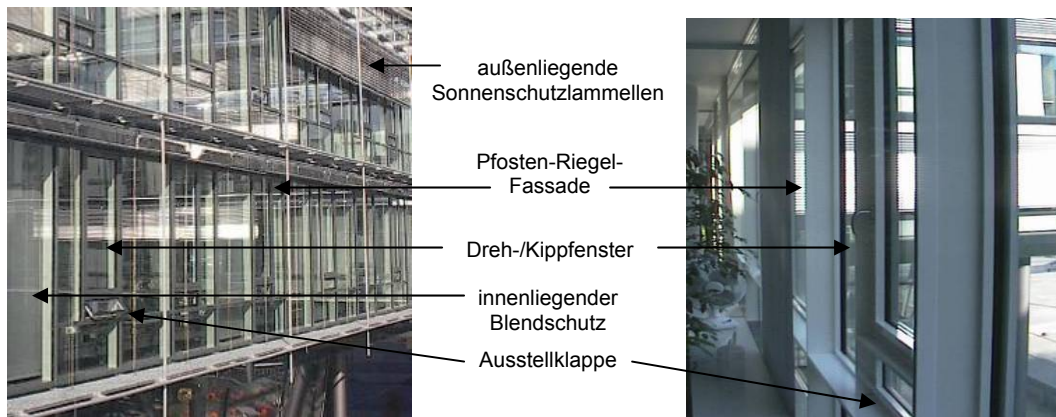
Details der Fassade zum Innenhof (IGS)
